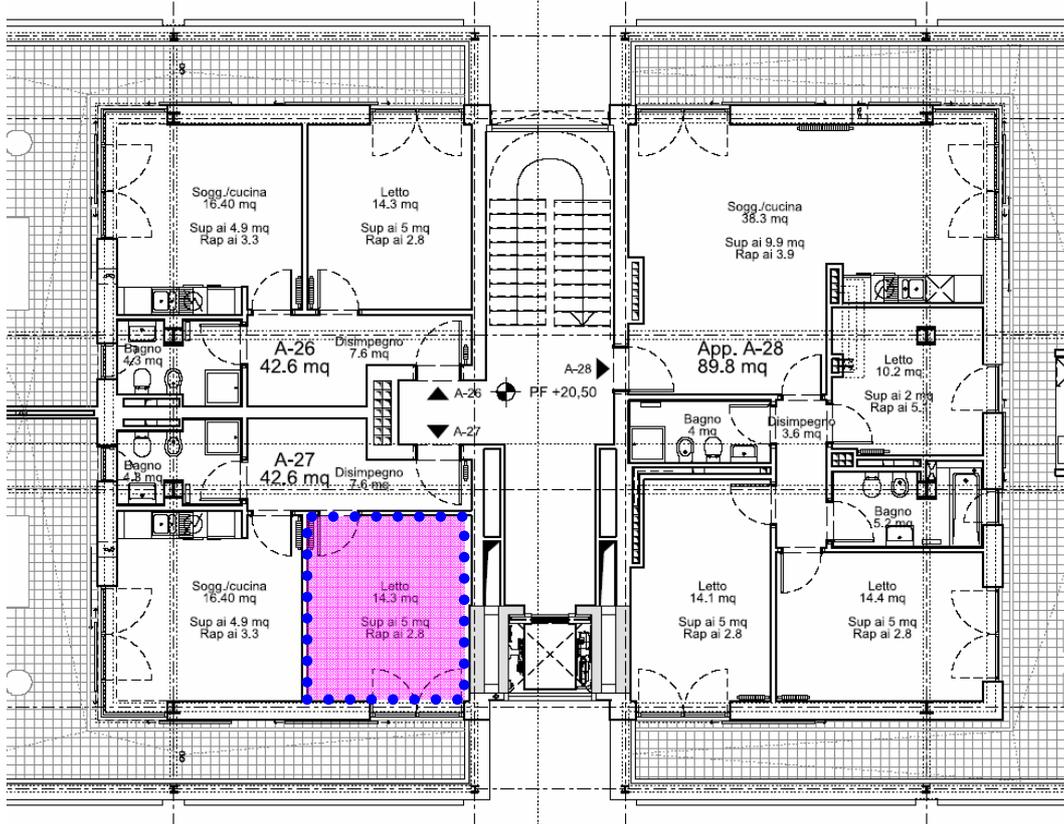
Indicazione della porzione di solaio oggetto di verifica al piano attico
